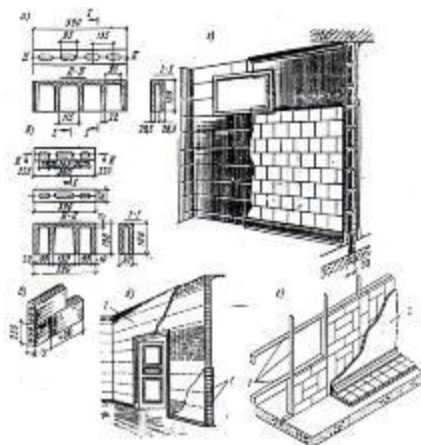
Перегородки из мелкоборных элементов: а-пустотная шлакобетонная плита; б-шлакобетонный блок; в-пустотный керамический блок; г-шлакобетонные плиты; 1-ленточный металлический каркас; 2-песчаная подготовка.
